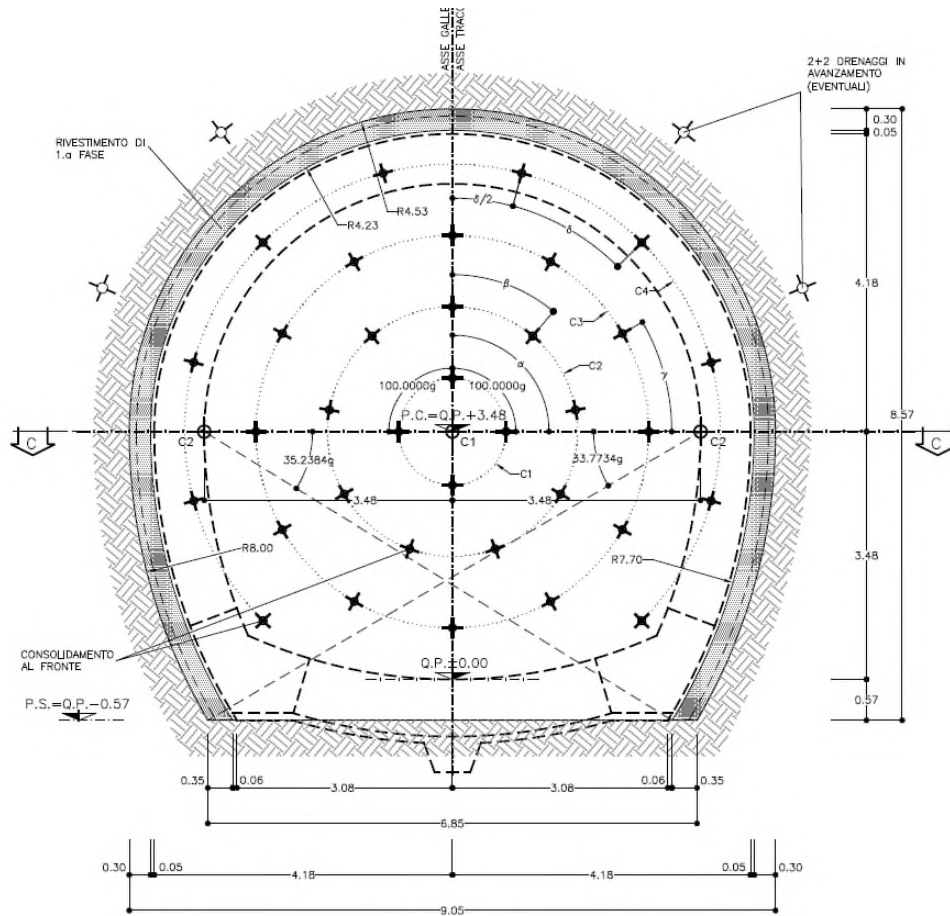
Sezione Tipo B2P – Scavi e consolidamenti - Sezione
